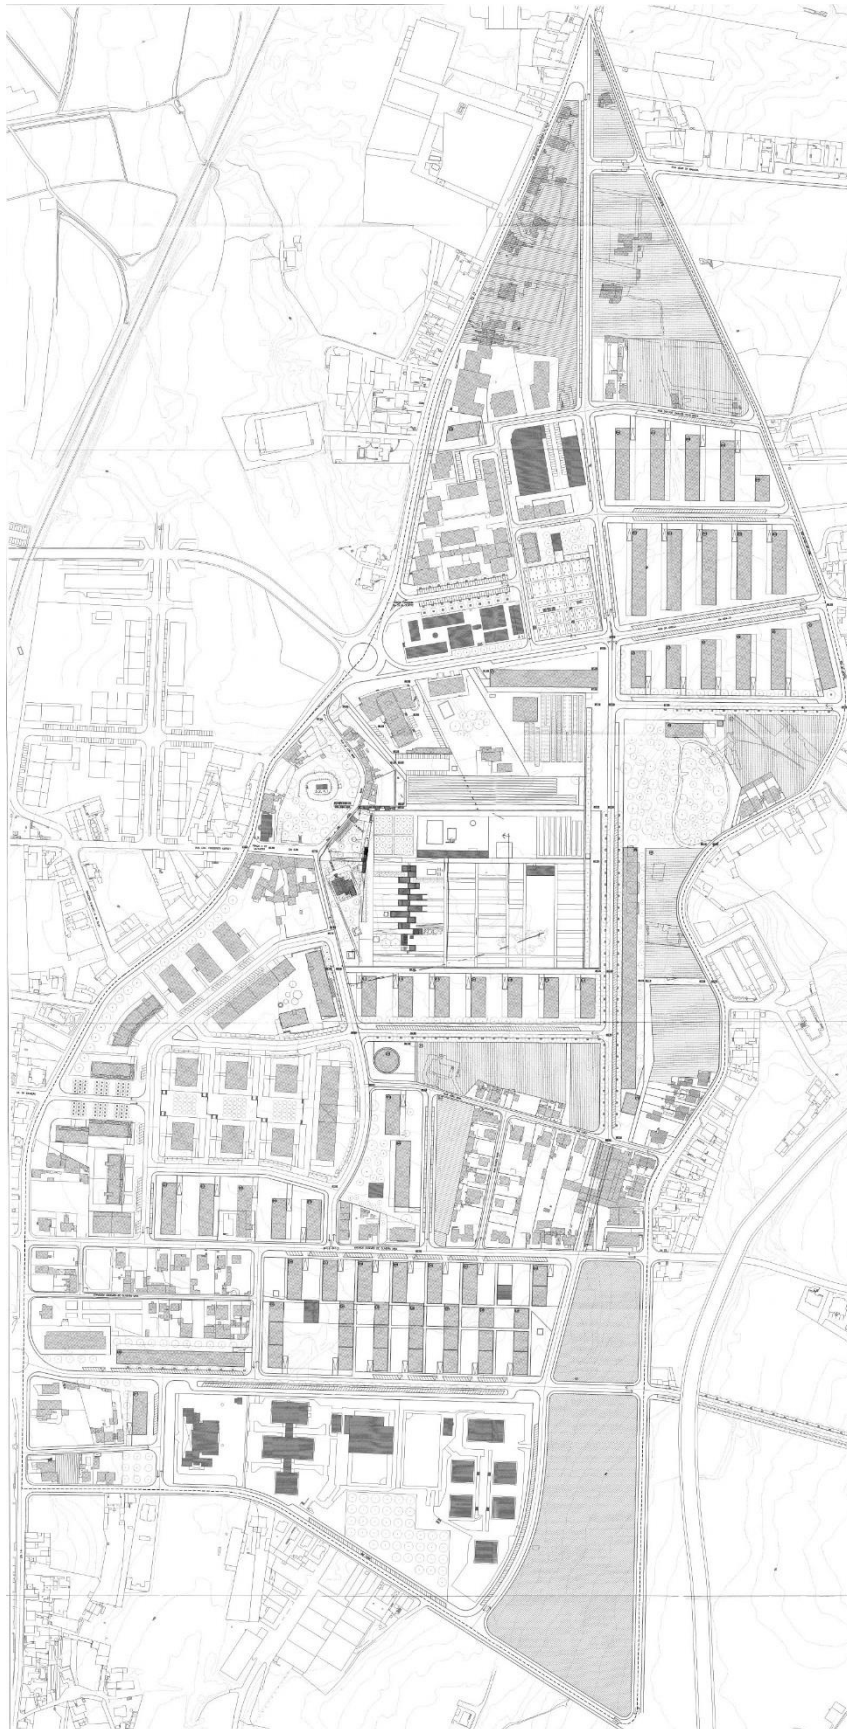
Planta do Plano de Pormenor, João Álvaro Rocha
